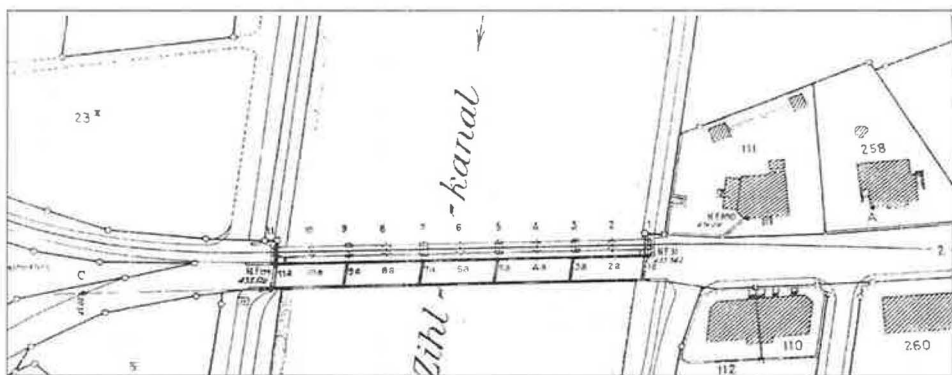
Ausschnitt aus Plan von Grundbuchgeometer E. Vogel, 1932, 1:1000, verkleinert. Strassenbrücke Kanton 1869/70 und Bahnbrücke der BTI 1914/15 über den Nidau-Büren-Kanal (Archiv BTI). Beim südlichen Brückenkopf: Einmündung der Burgerallee (in den 1960er-Jahren verbreitert) von Westen mit Überquerung des Trassees der BTI-Bahn und des Schleusenweges von Osten in die Hauptstrasse. Beim nördlichen Brückenkopf: Einmündung des Unteren Kanalweges von Osten in die Hauptstrasse.
